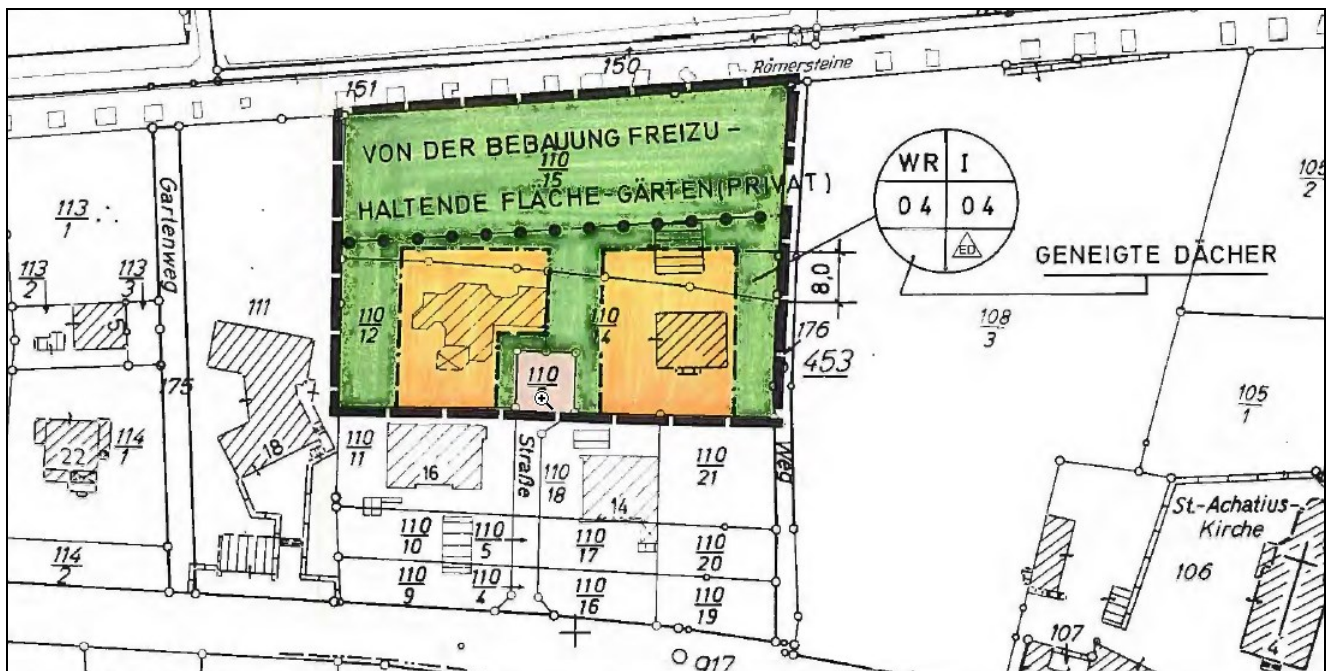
Rechtskräftiger Bebauungsplan „An den Römersteinen - Teil II (Z 58/II, 1. Ä)“
